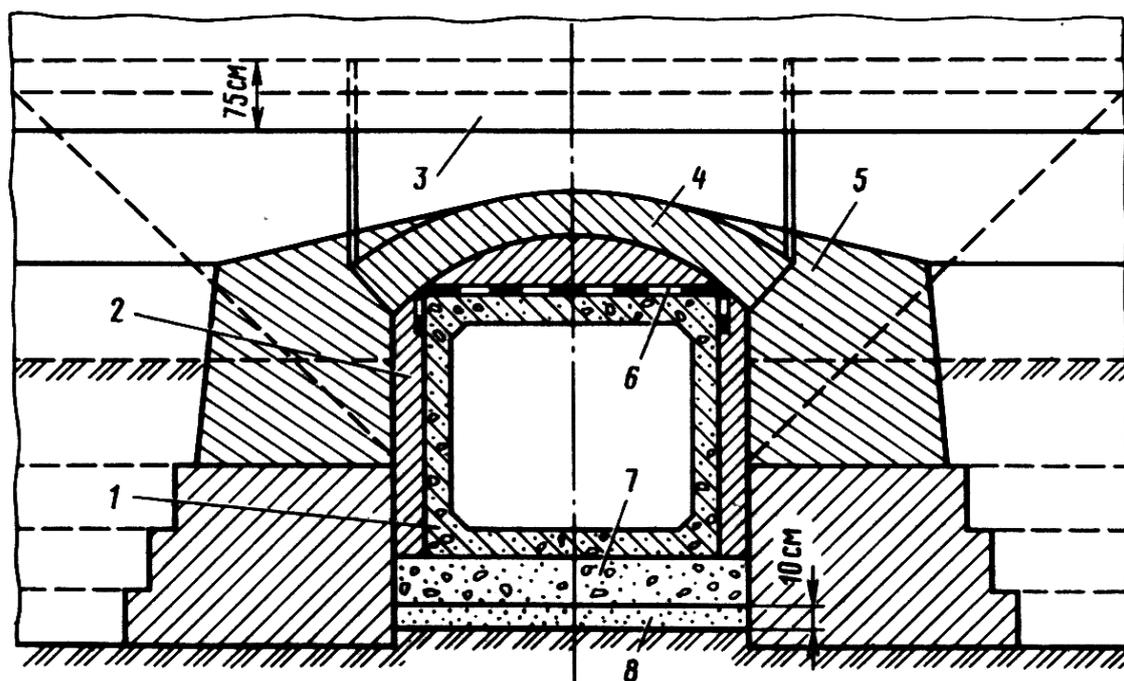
Переустройство каменного моста в трубу: 1 – прямоугольная железобетонная труба; 2 – бетон, 3 – щековые стенки моста, разбираемые на высоту 75 см, 4 – свод переустраиваемого моста; 5 – каменная кладка; 6 – гидроизоляция трубы; 7 – фундамент трубы; 8 – щебень
